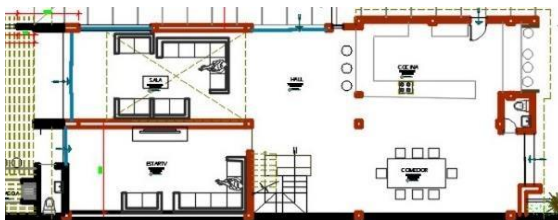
Primera Planta del Bloque Principal Fuente: Elaboración Propia.
